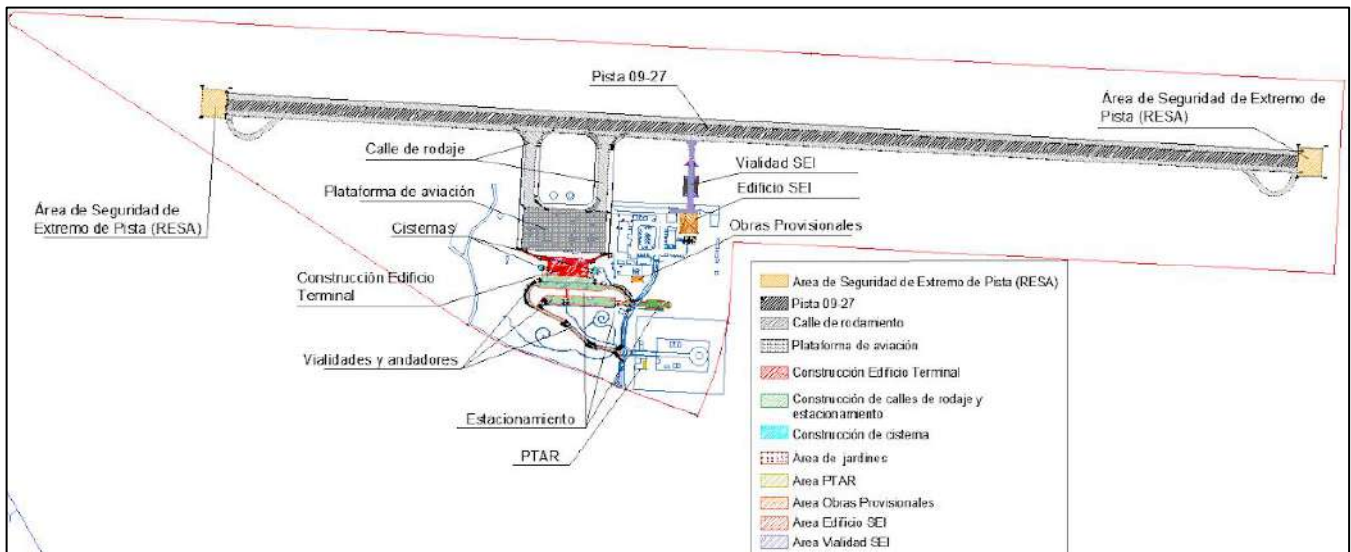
Planta de ubicación de superficies del Proyecto.
